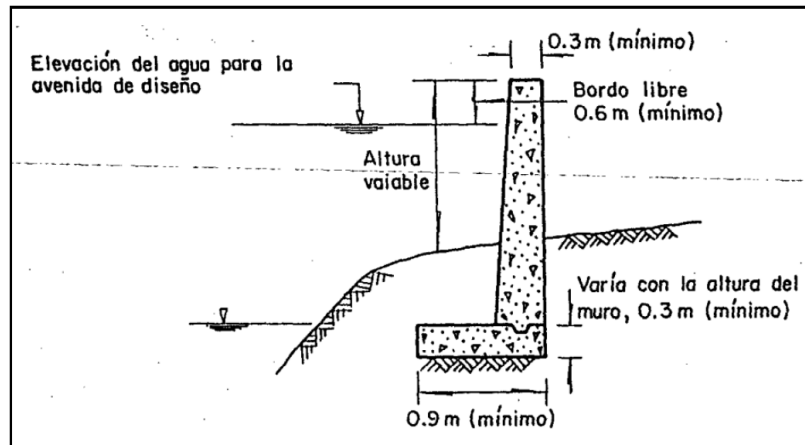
Sección transversal de un muro de encauzamiento (Maza, 2000).
